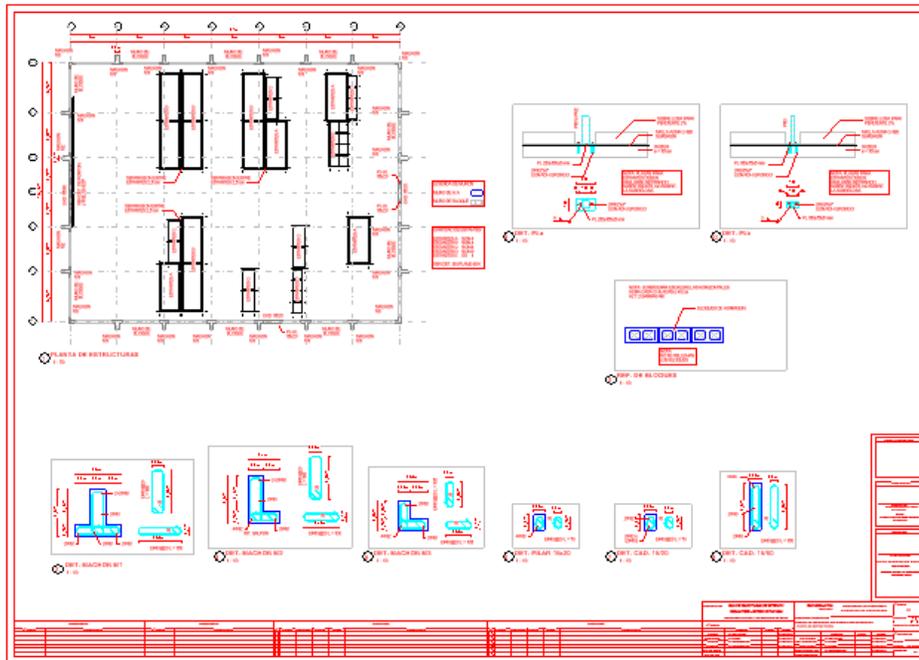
Ejemplo plano de planta de una estructura en Revit. Fuente: Archivos Ing. Eduardo Jerez
